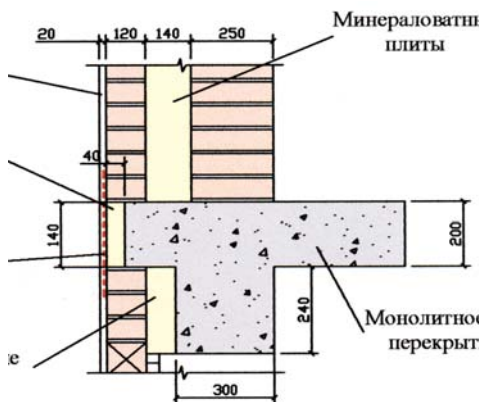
б Узел сопряжения лицевого слоя кладки с плитой перекрытия
